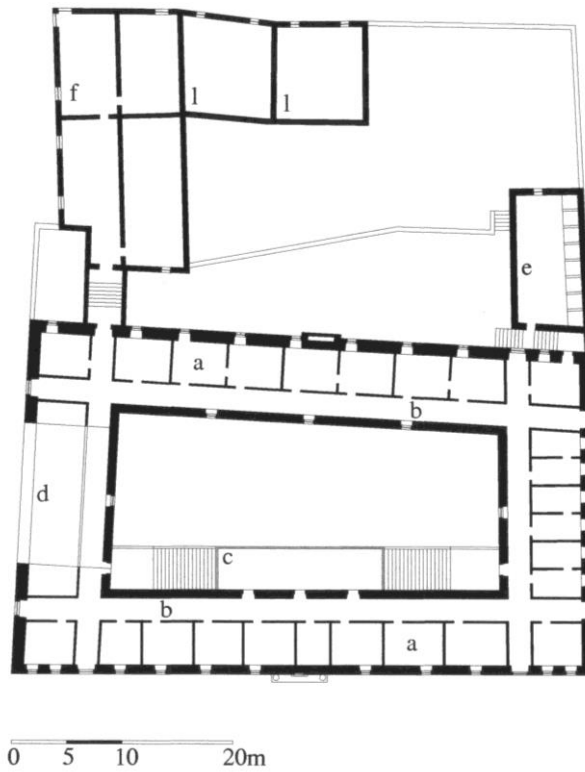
Planta do primeiro andar do colégio de São Paulo (do autor).
